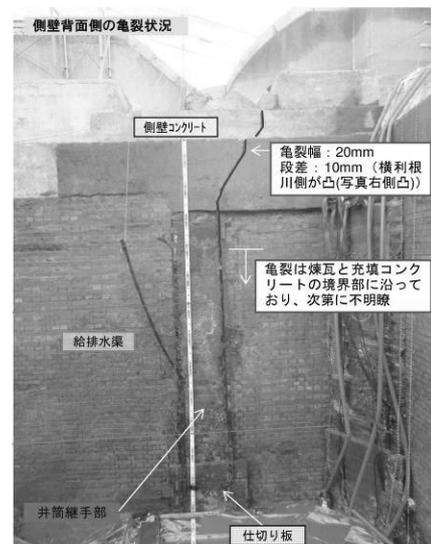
裏閘扉室左岸の裏側に生じた亀裂
